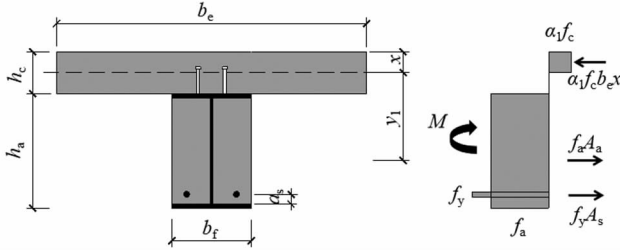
中和轴位于混凝土翼板内时的 T 形组合梁截面及应力示意
